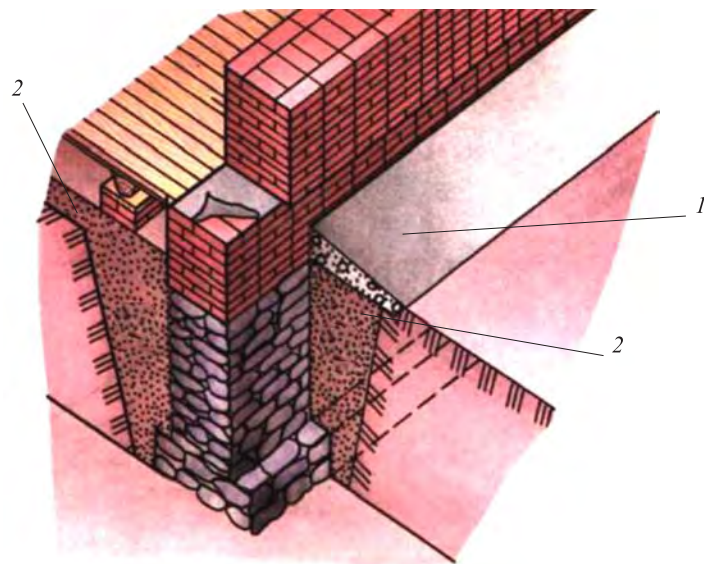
Ленточный бутовый фундамент: 1 — отмостка, 2 — обратная засыпка грунтом
